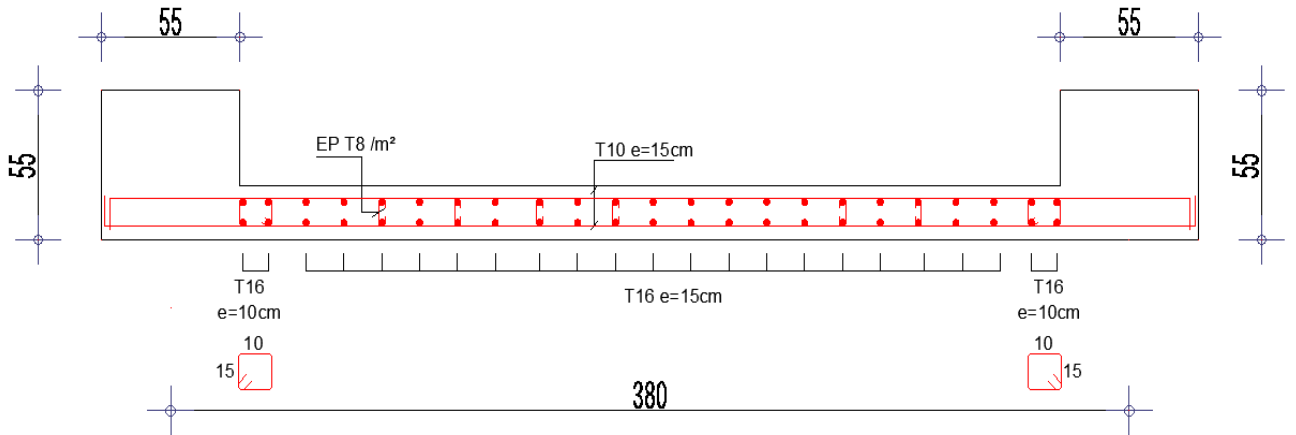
Schéma exemple de ferrailages voiles VY1 Zone I
